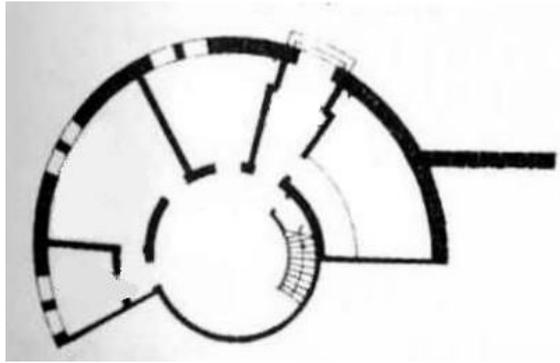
Planta subterránea de la “Casa Redonda”
